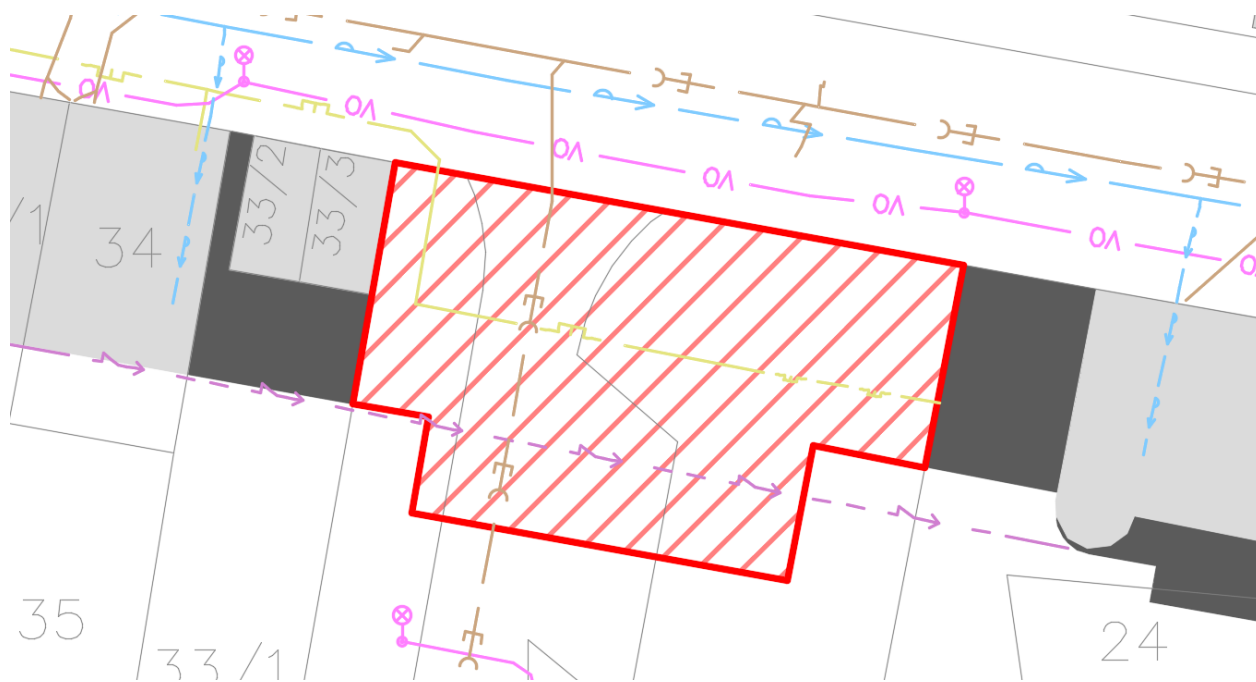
Orientační vyznačení kolmých parkovacích stání v rámci veřejného prostoru B
